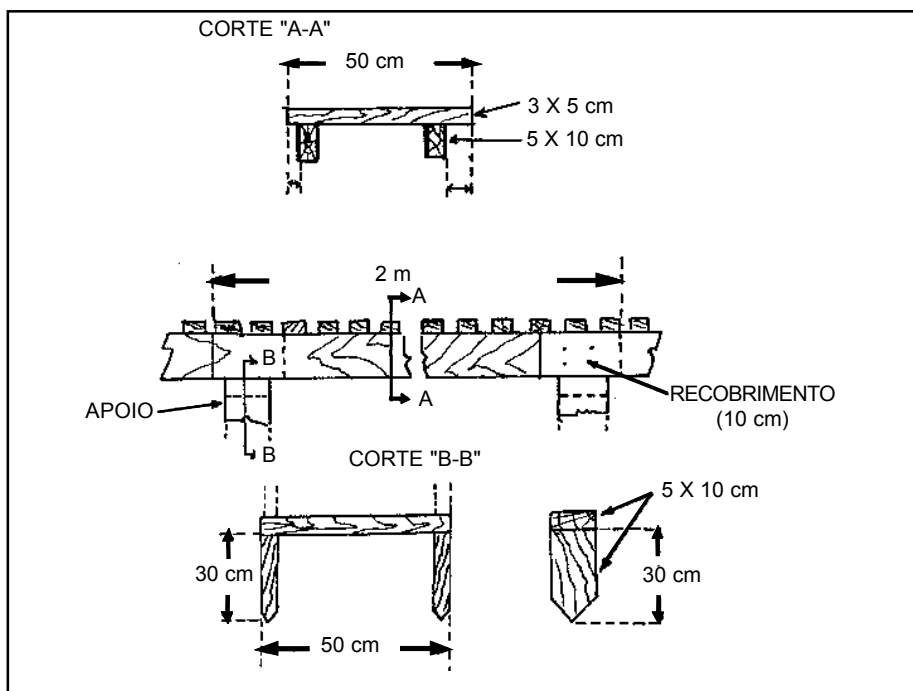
Detalhes do estrado da trincheira e seu apoio
